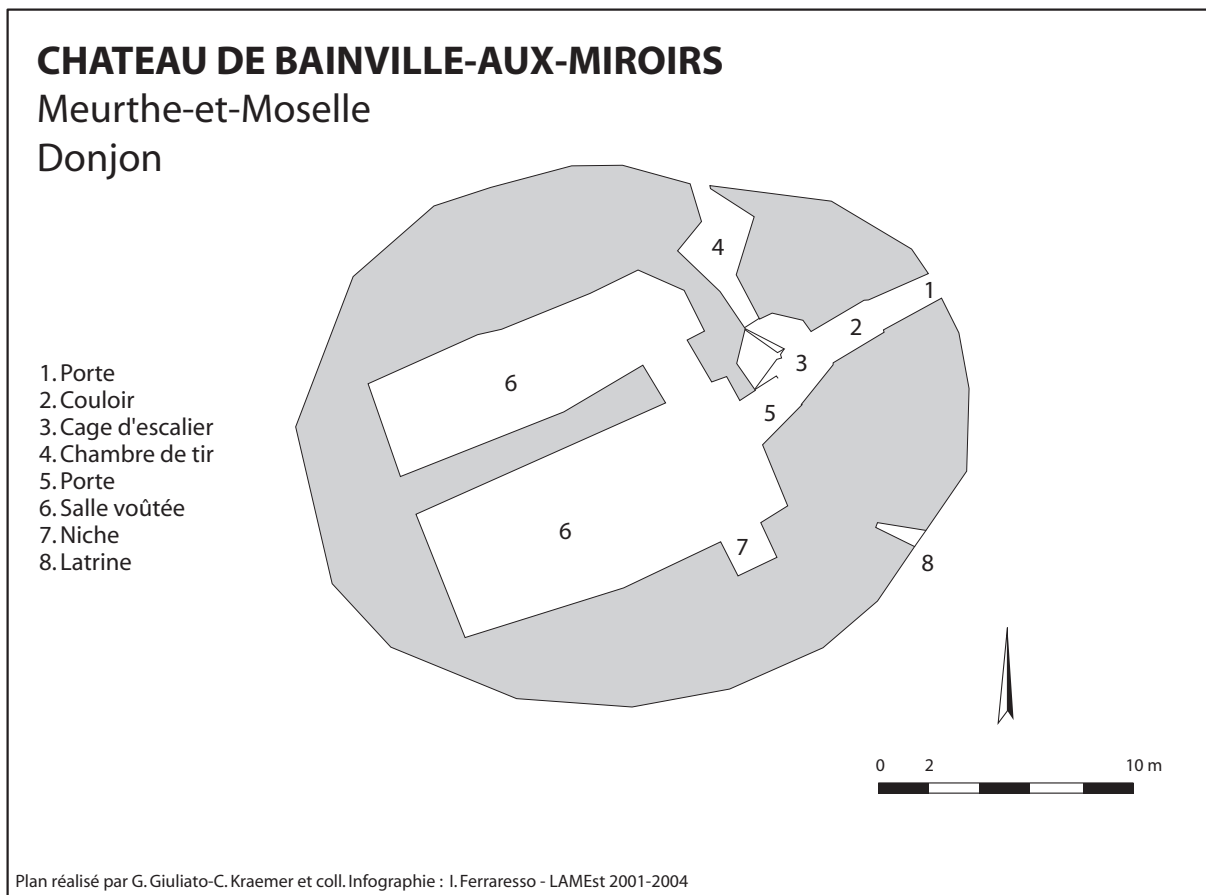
Plan de la tour sud-ouest du château (d'après GIULIATO 2008, p. 29)
